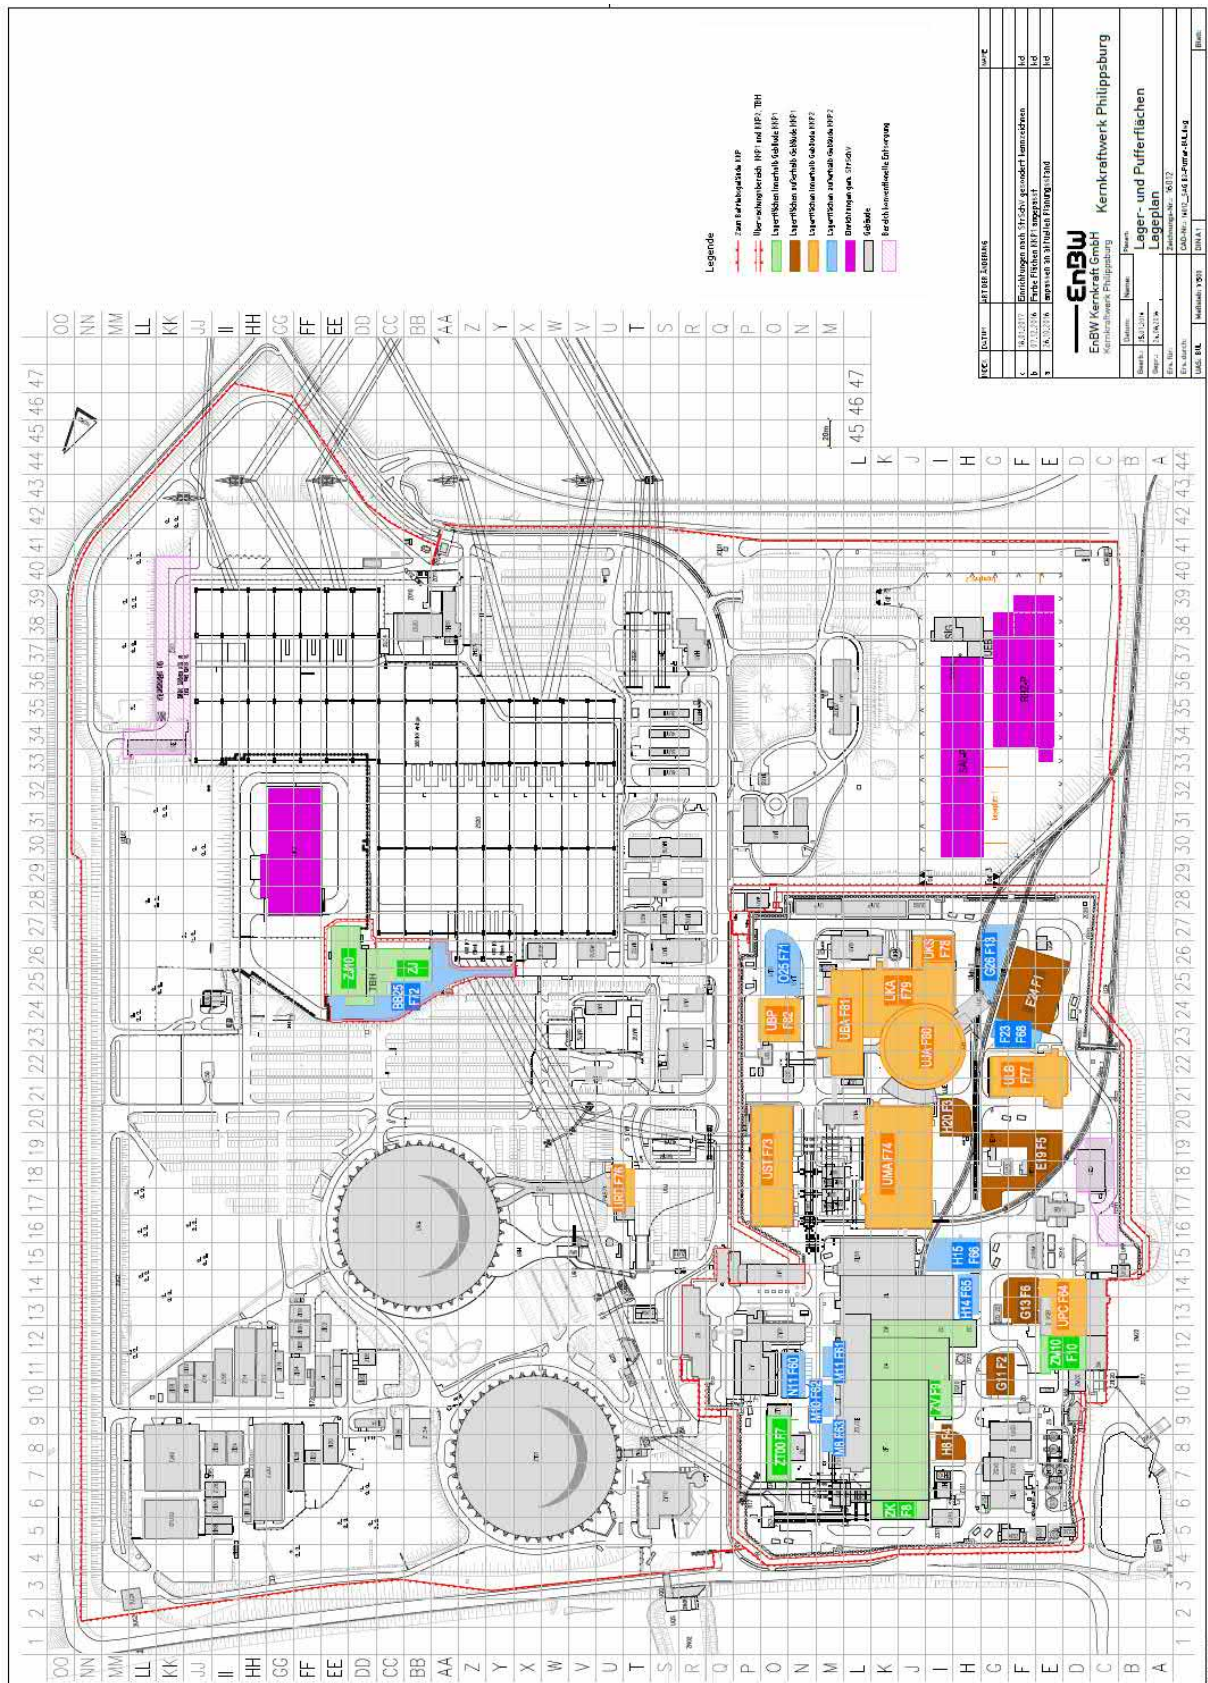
Lage der Vorhabensflächen der SAG KKP 2 (orange Lagerflächen innerhalb Gebäuden, blau Lagerflächen außerhalb von Gebäuden) (EnKK Lager- und Pufferflächenplan 2016)
